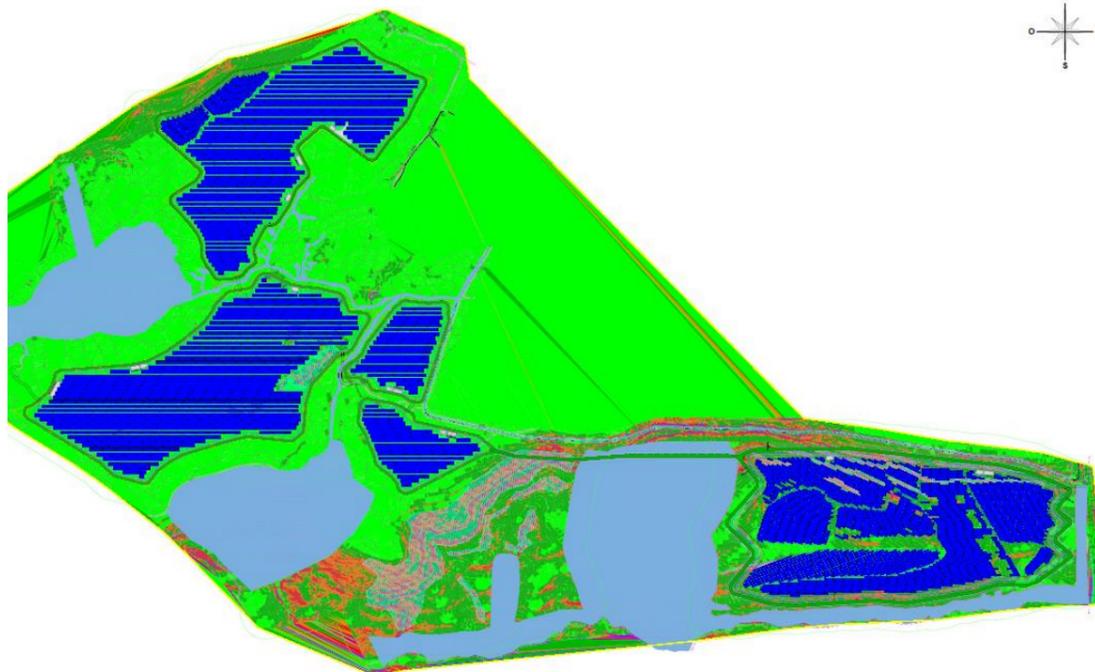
Plan de masse de la version 3 (janvier 2020)
